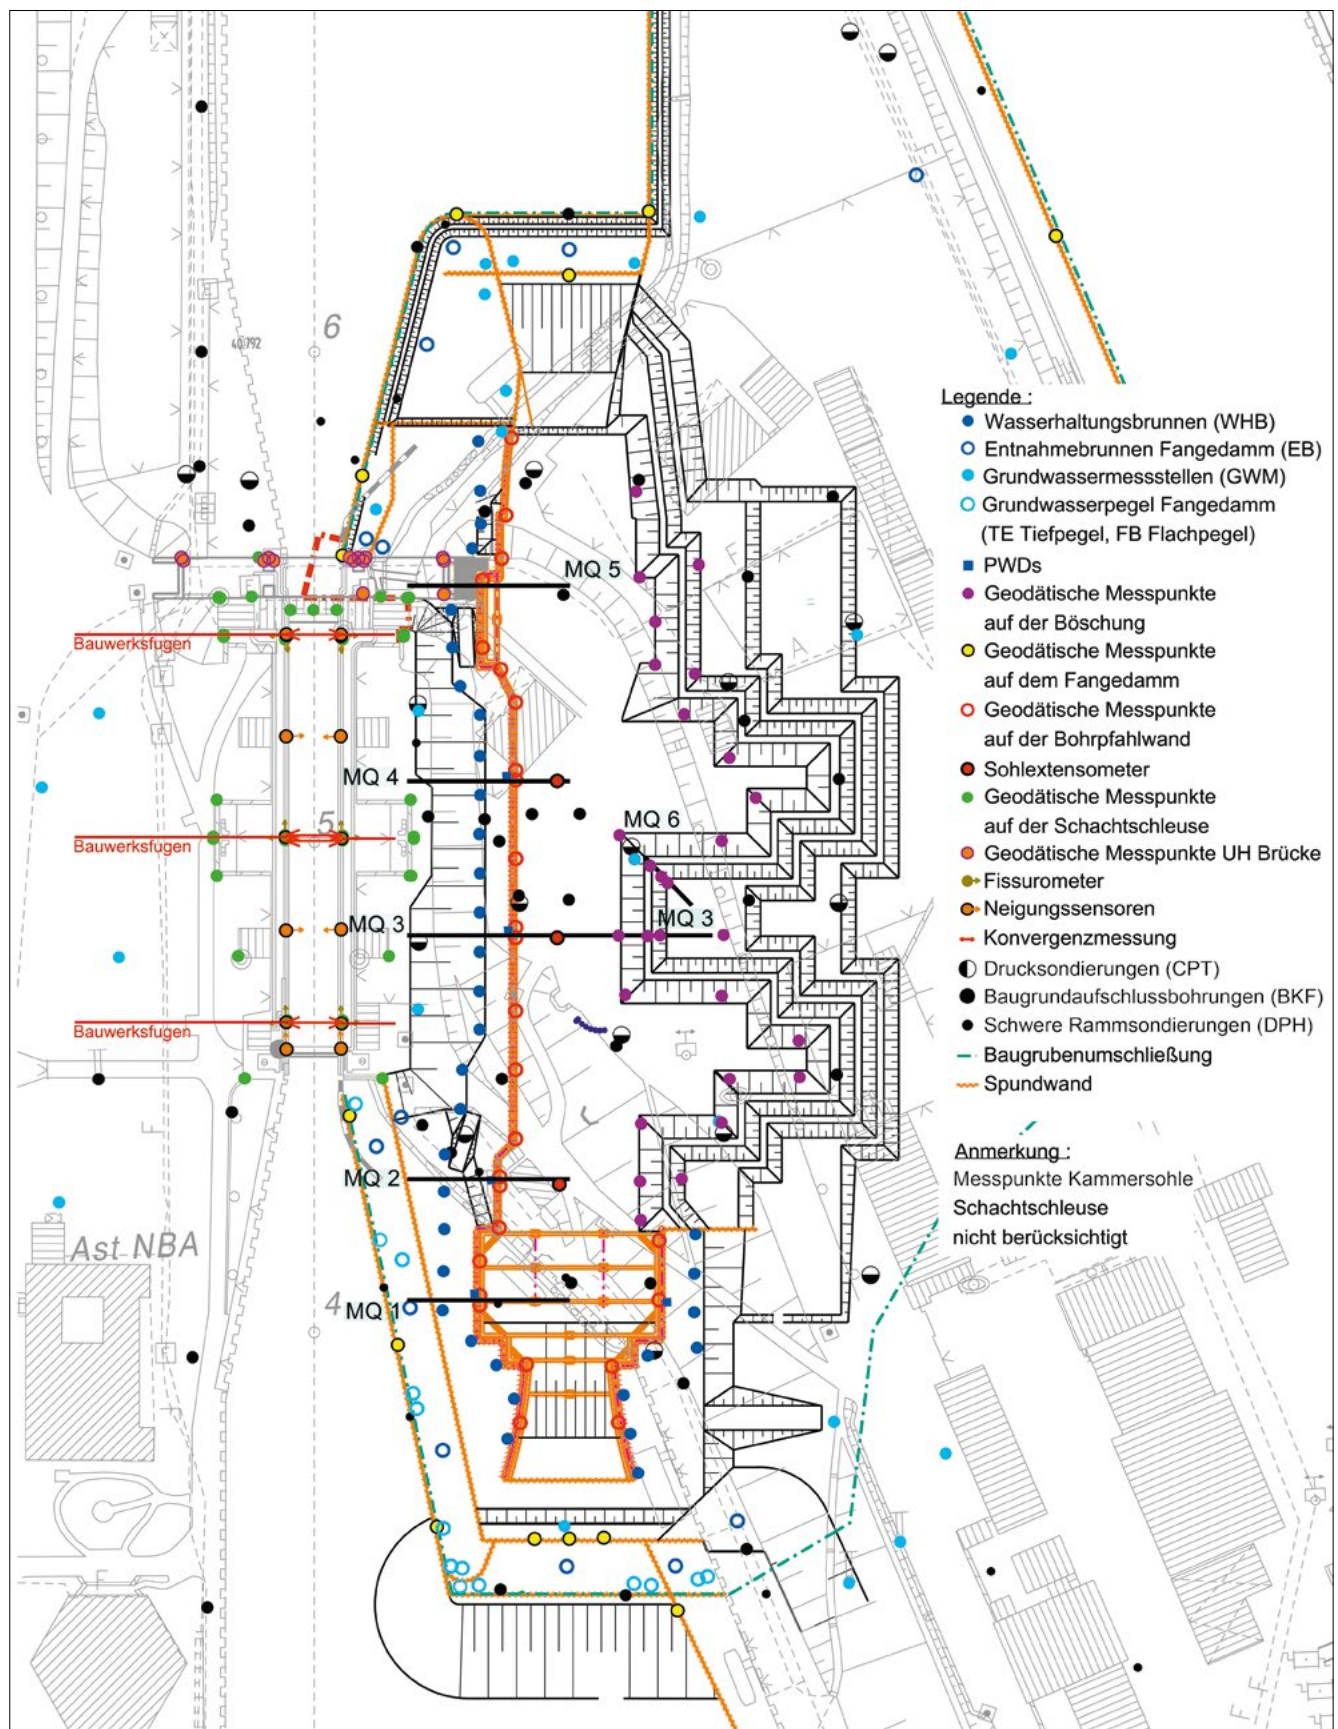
Lageplan der Baugrube mit Anordnung der geotechnischen Messquerschnitte (Quelle: BAW)
